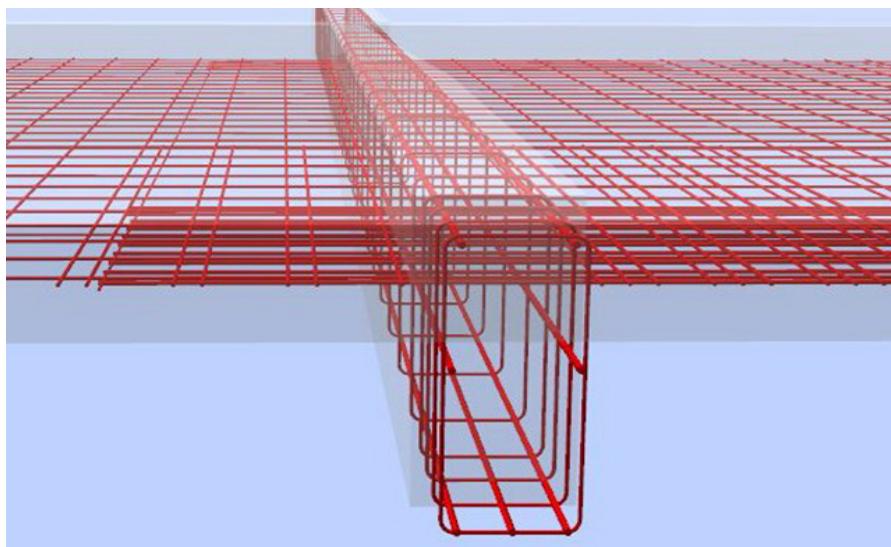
Окончательная сборка пространственного арматурного каркаса балки (ригеля)
